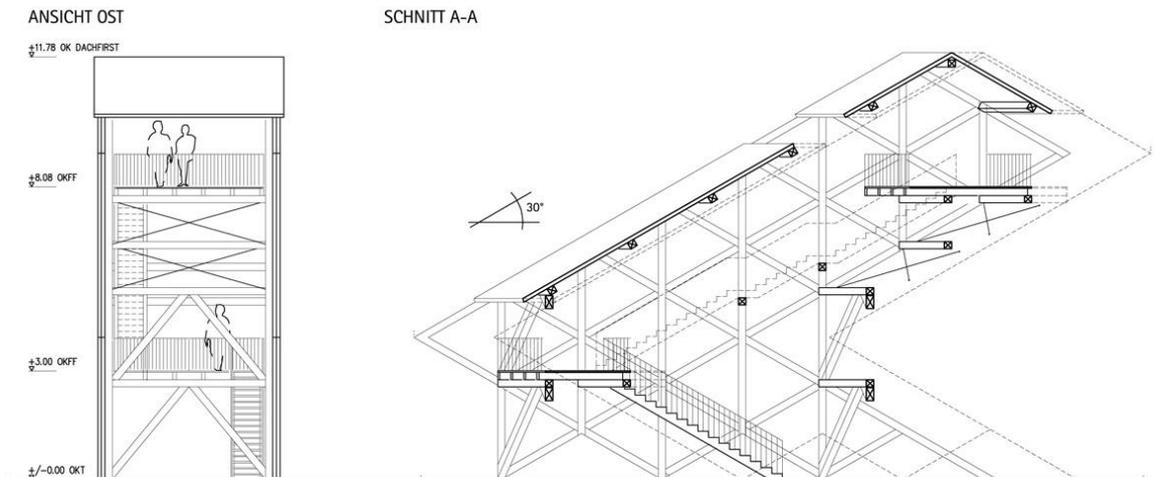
Alzado Oeste y Sección Longitudinal Fuente: plataformaarquitectura.cl/cl/02-16403/torre-de-observacion-de-aves-gmp-architekten
